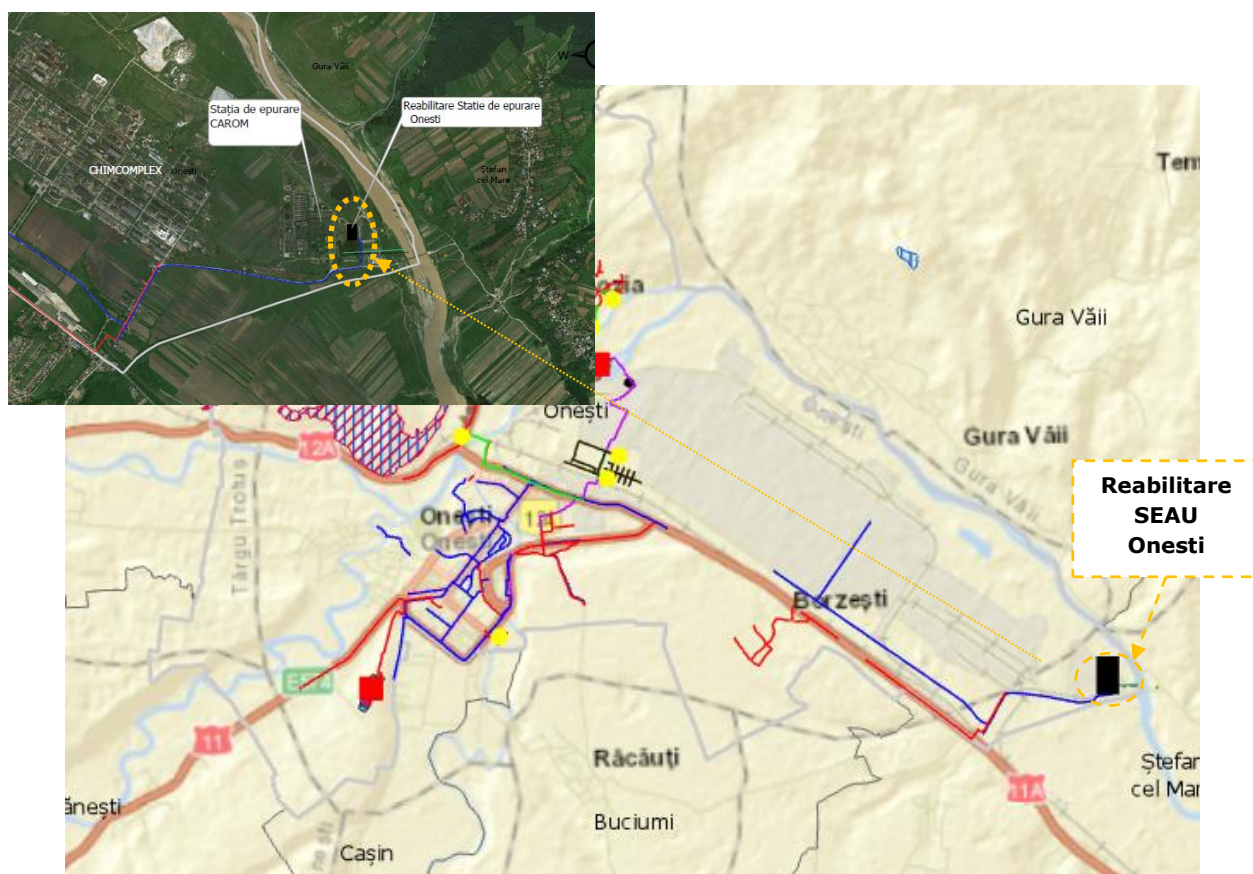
4: Plan de încadrare în zonă – Stația de epurare Onești
